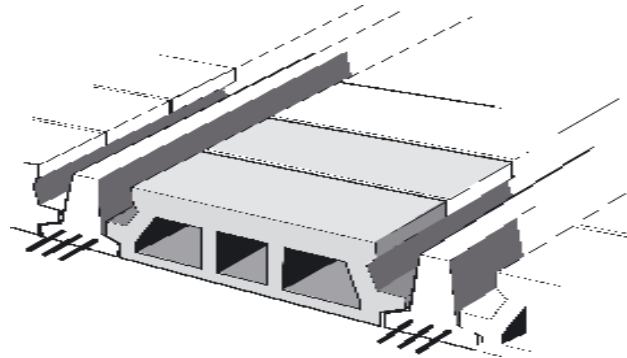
Vue d'un coup vertical Plancher en corps creux. [1]
